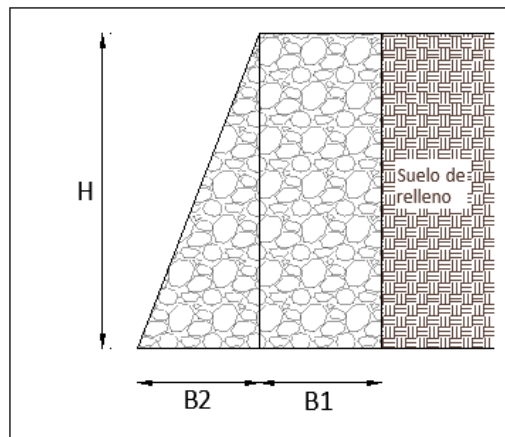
Muro de gravedad sección trapezoidal rectangular.
